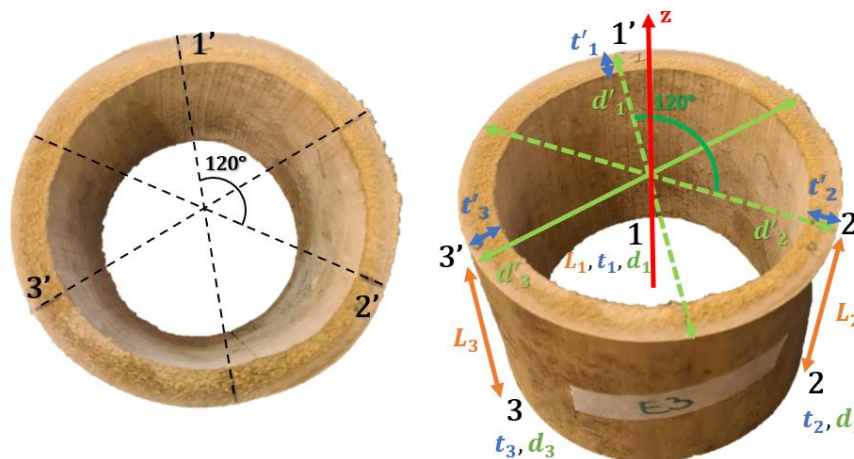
Dimensions et mesures des échantillons de bambou
